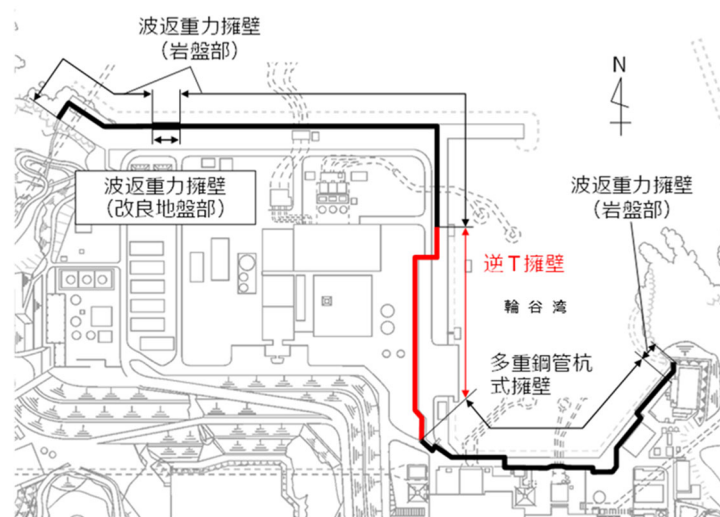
防波壁（逆 T 擁壁）の平面配置図
